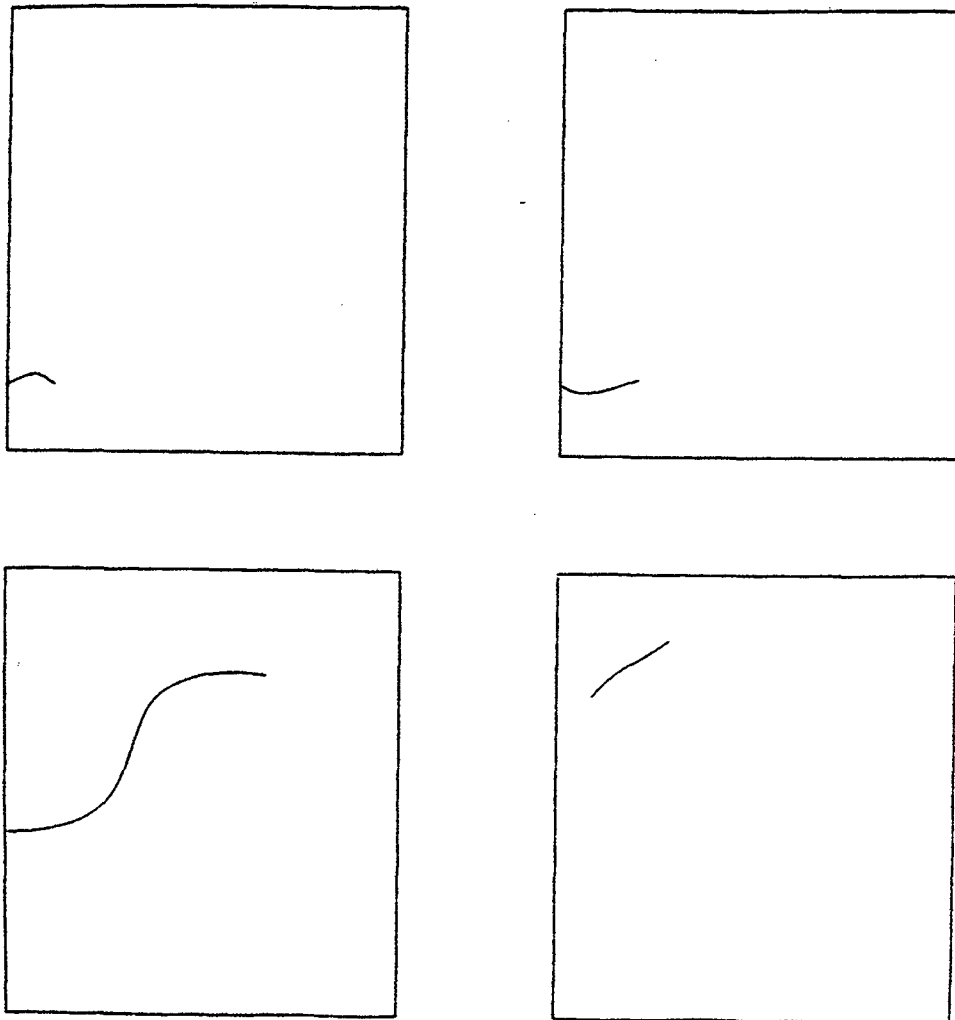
Fissuras típicas. [Guerrieri, 1998]
